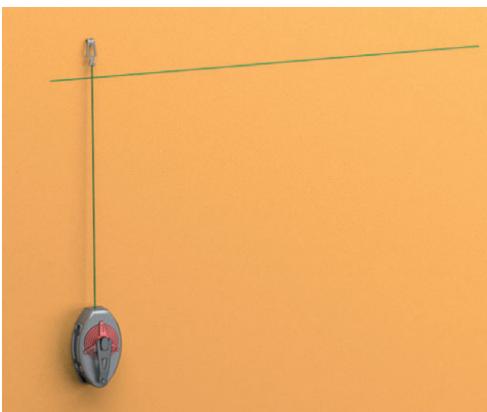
Порядок монтажа проводки в ПВХ-трубах, шаг первый: выполняется разметка стены при помощи отбивки — окрашенной нити
